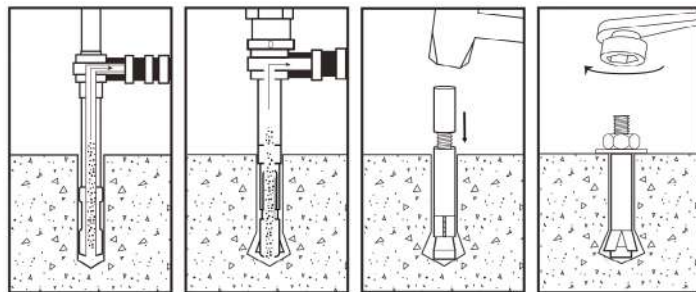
Secuencia de instalación de un anclaje de expansión mecánica: 1) Perforación; 2) Corte o ensanchado de la base; 3) Fijación; y 4) Apriete.
